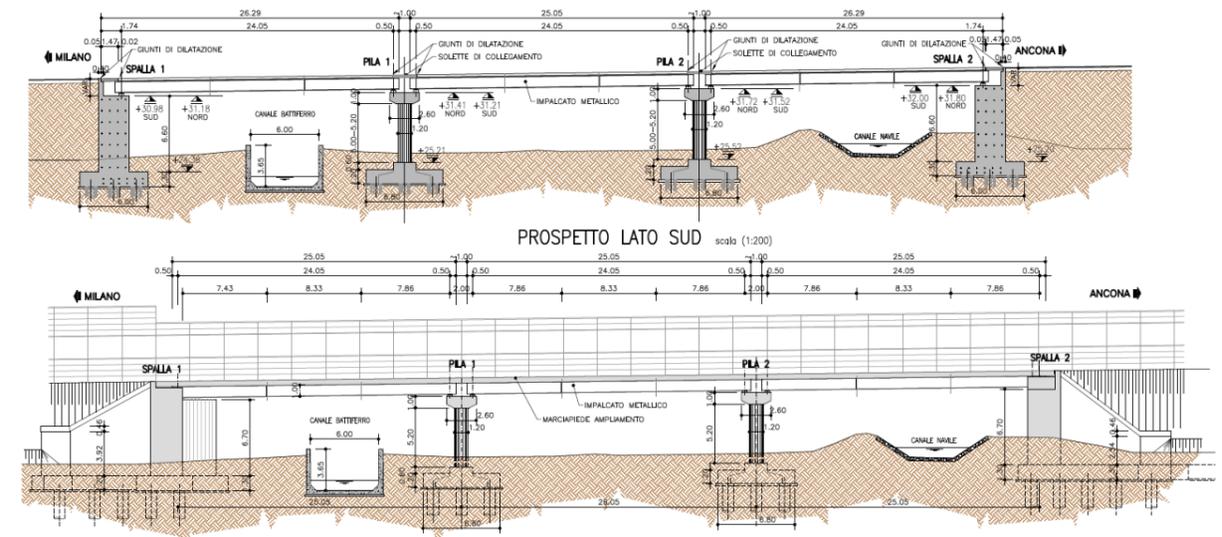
Prospetto lato sud ponte sul canale Navile²⁴
